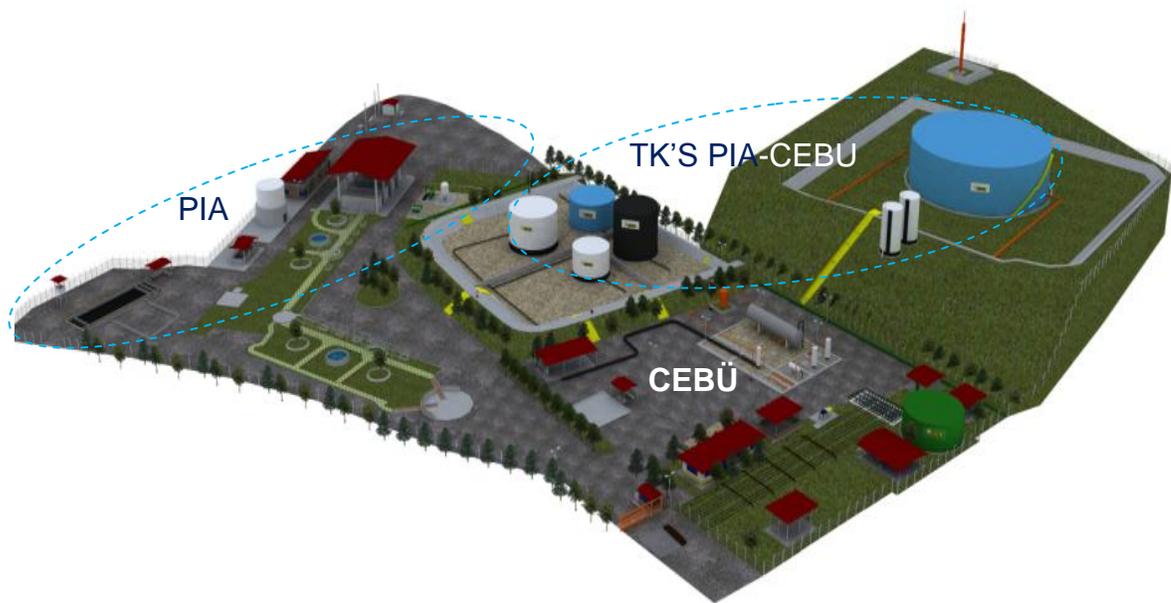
Batería Cebú y Planta de Inyección de Agua PIA
